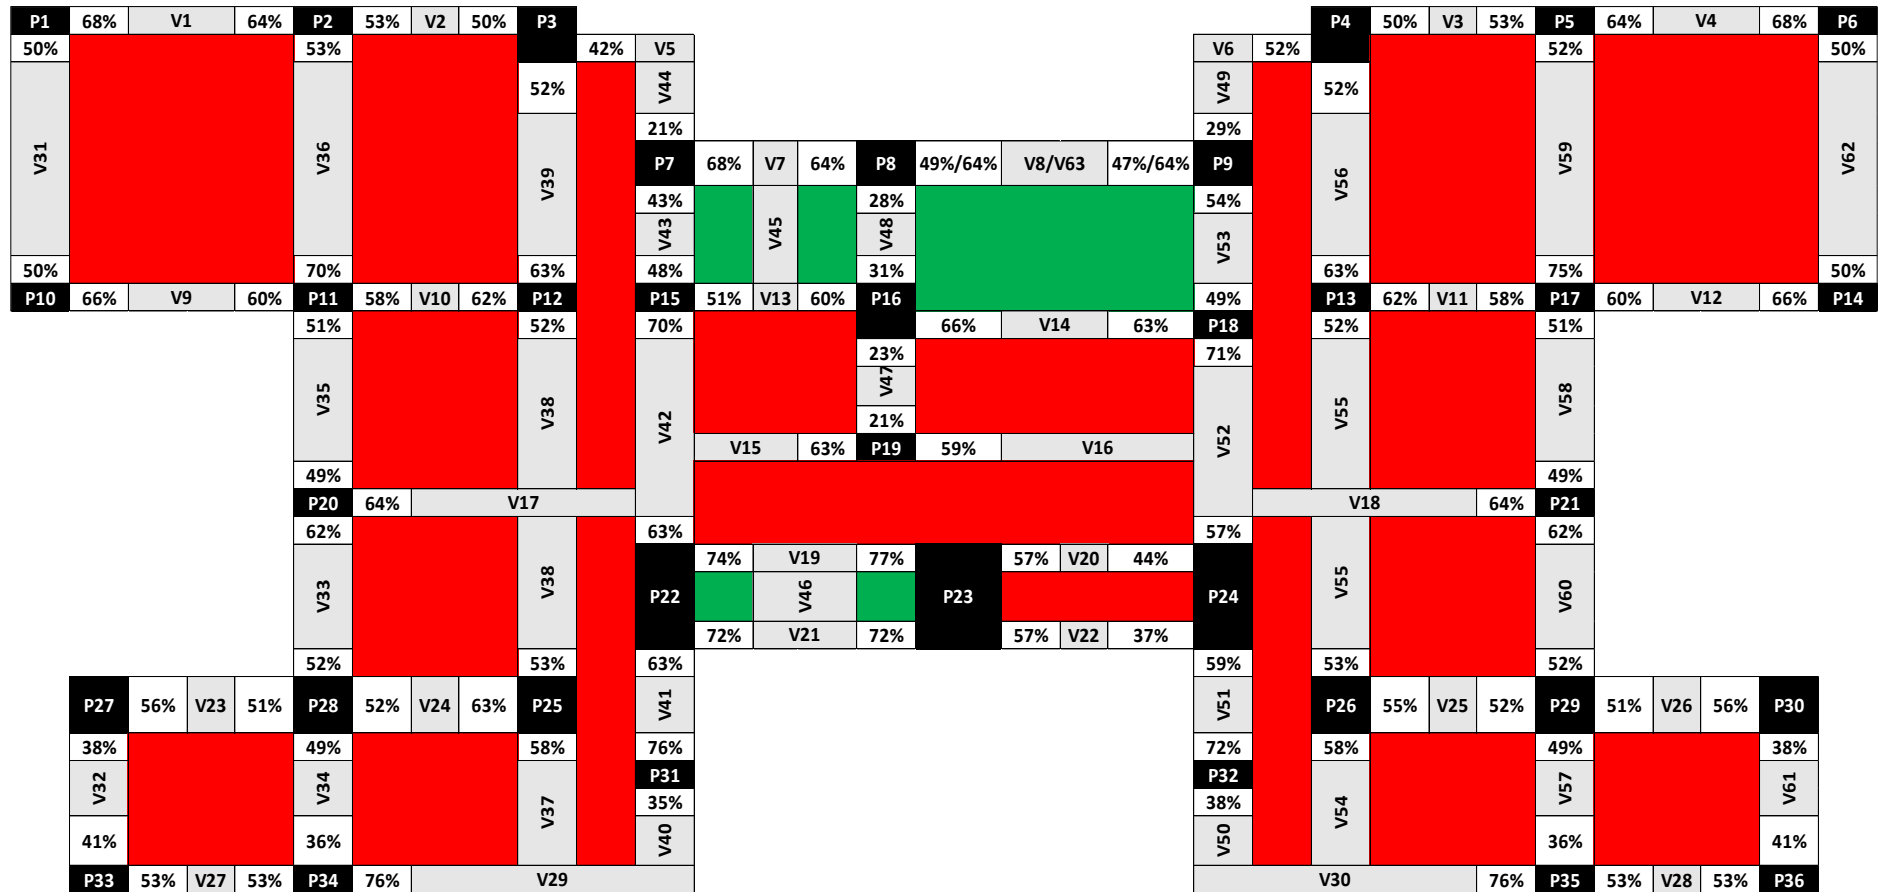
Área de aço (cm²) do pavimento mezanino para a iteração 4
